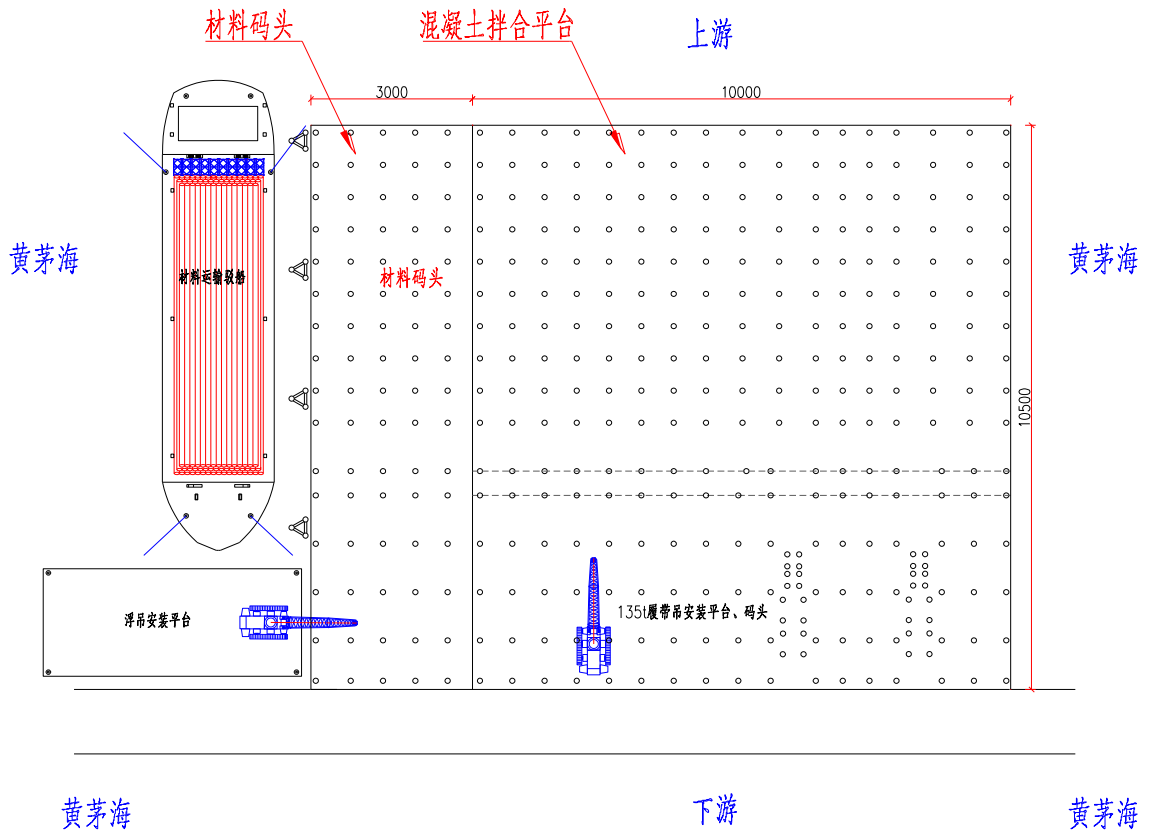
水上拌和平台、材料码头施工平面图
